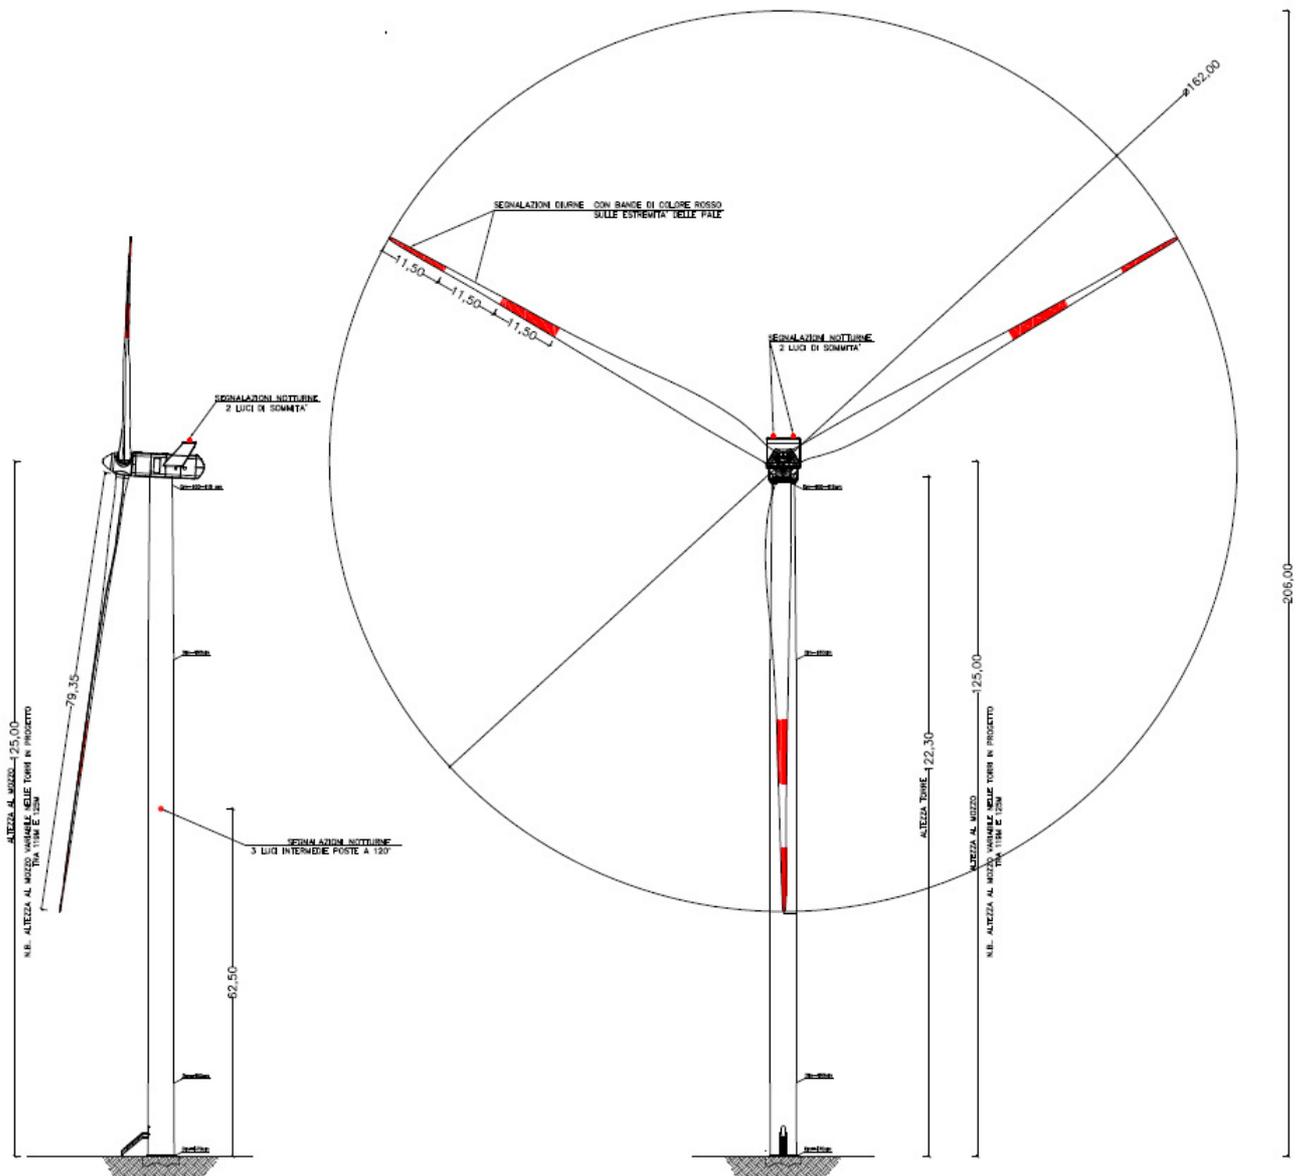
Prospetto e sezione dell'aerogeneratore tipo VESTAS – V162-6 MW
